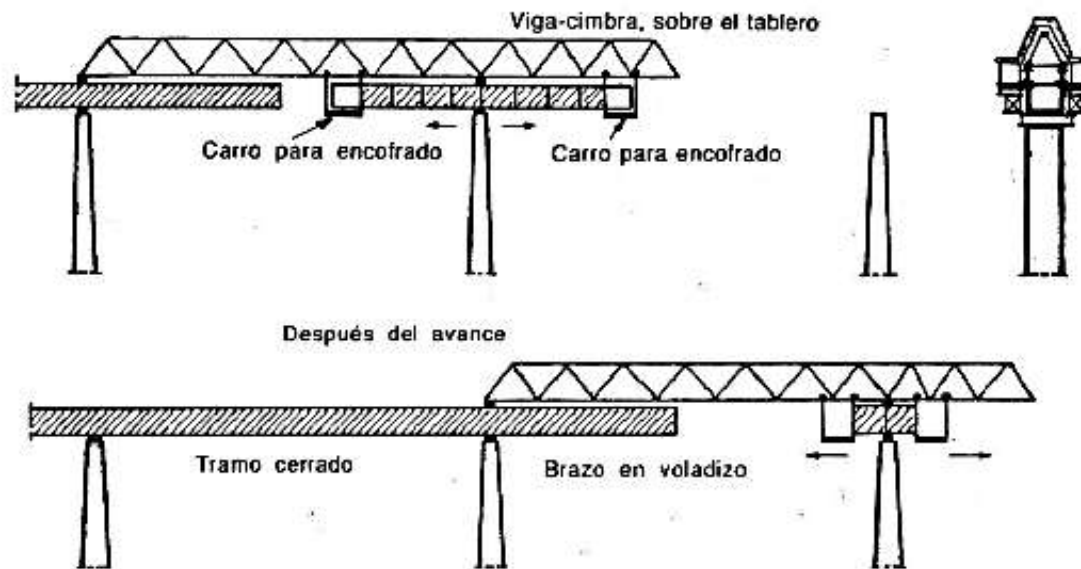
Viga Cimbra Reticulada, sobre el puente, para avance de los carros para encofrado y para la estabilización de los brazos en voladizo, que se apoyan sobre pilas altas, esbeltas.
